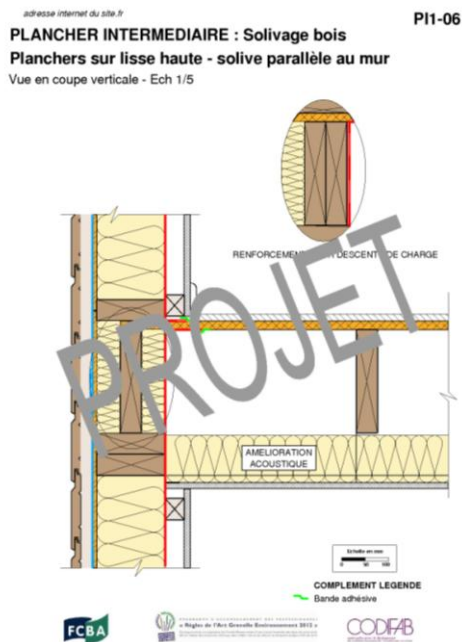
Extraits des carnets de détails des planchers, murs et toitures
